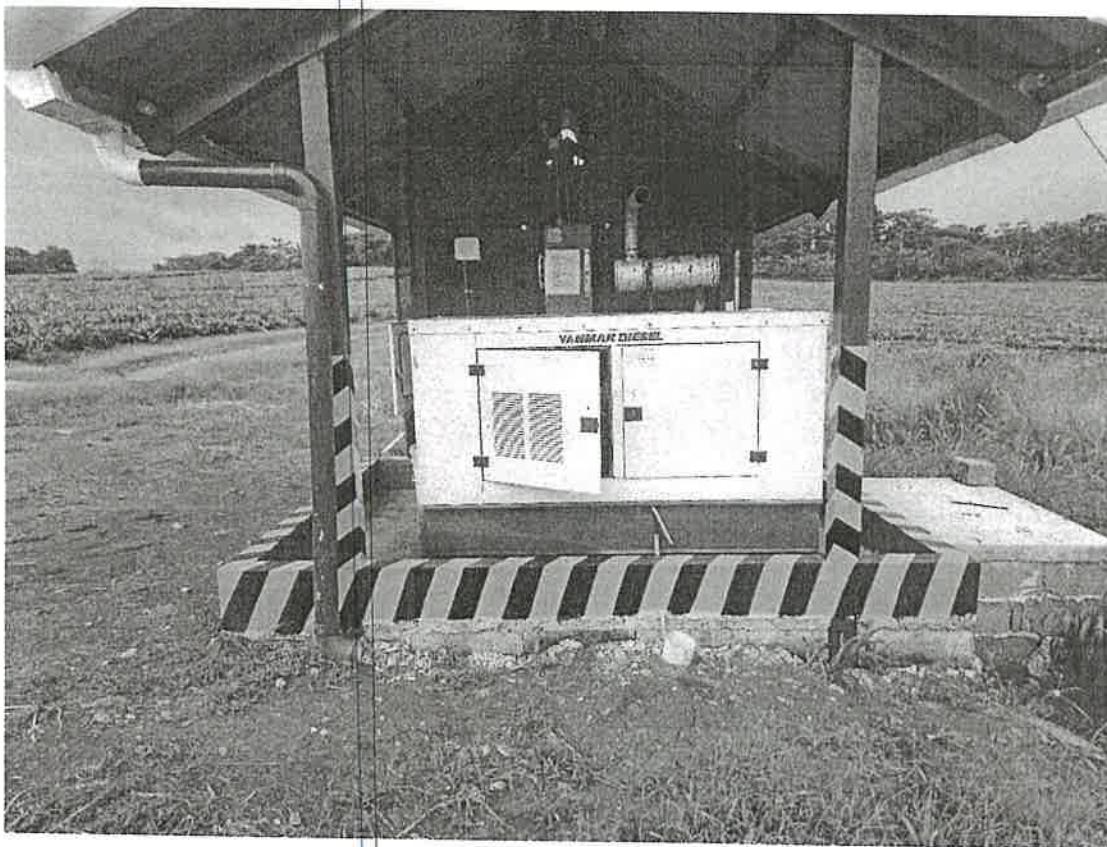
Vista Lateral muro antiderrame área planta eléctrica.
